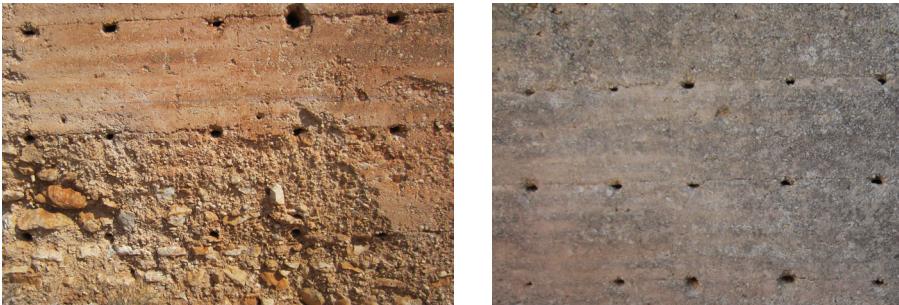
3.9. Detalle de la tapia en los alzados Sur y Norte de la torre Alédua.
